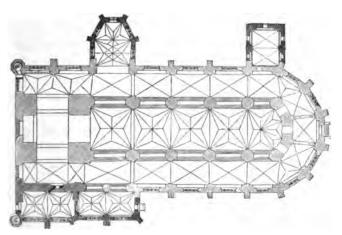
Wolgast. S. Petrikirche, Grundriss. 1:667.
